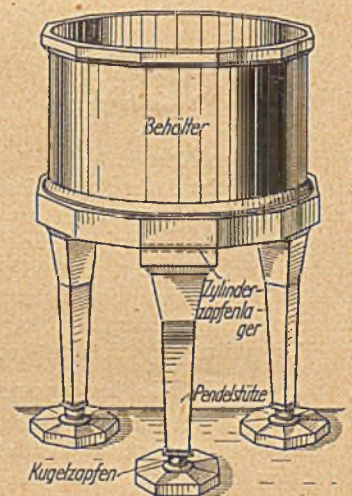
Schematische Darstellung eines Behälters mit Dreipunkt-Pendellagerung.
